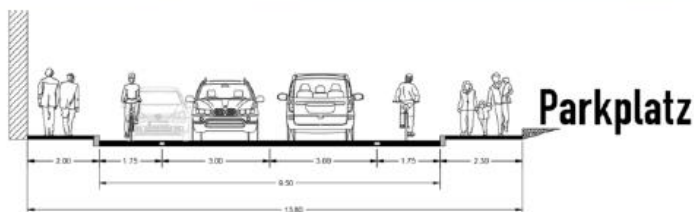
Bestehender Ausbau und Querschnitt der Eberstädter Straße im Bereich der Zufahrt zur ehemaligen Brauerei / Zufahrt zu den Einzelhandelseinrichtungen
